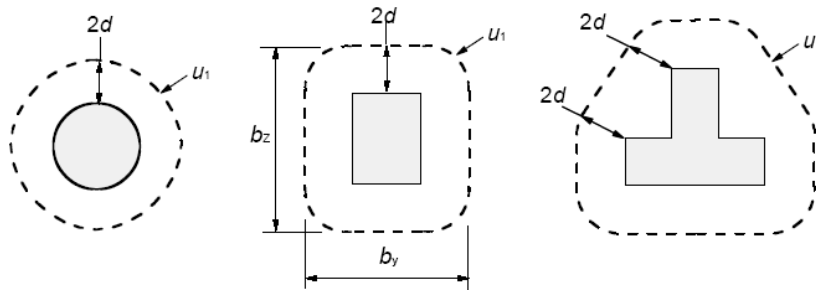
Typische kritische Rundschnitte um Lasteinleitungsflächen
